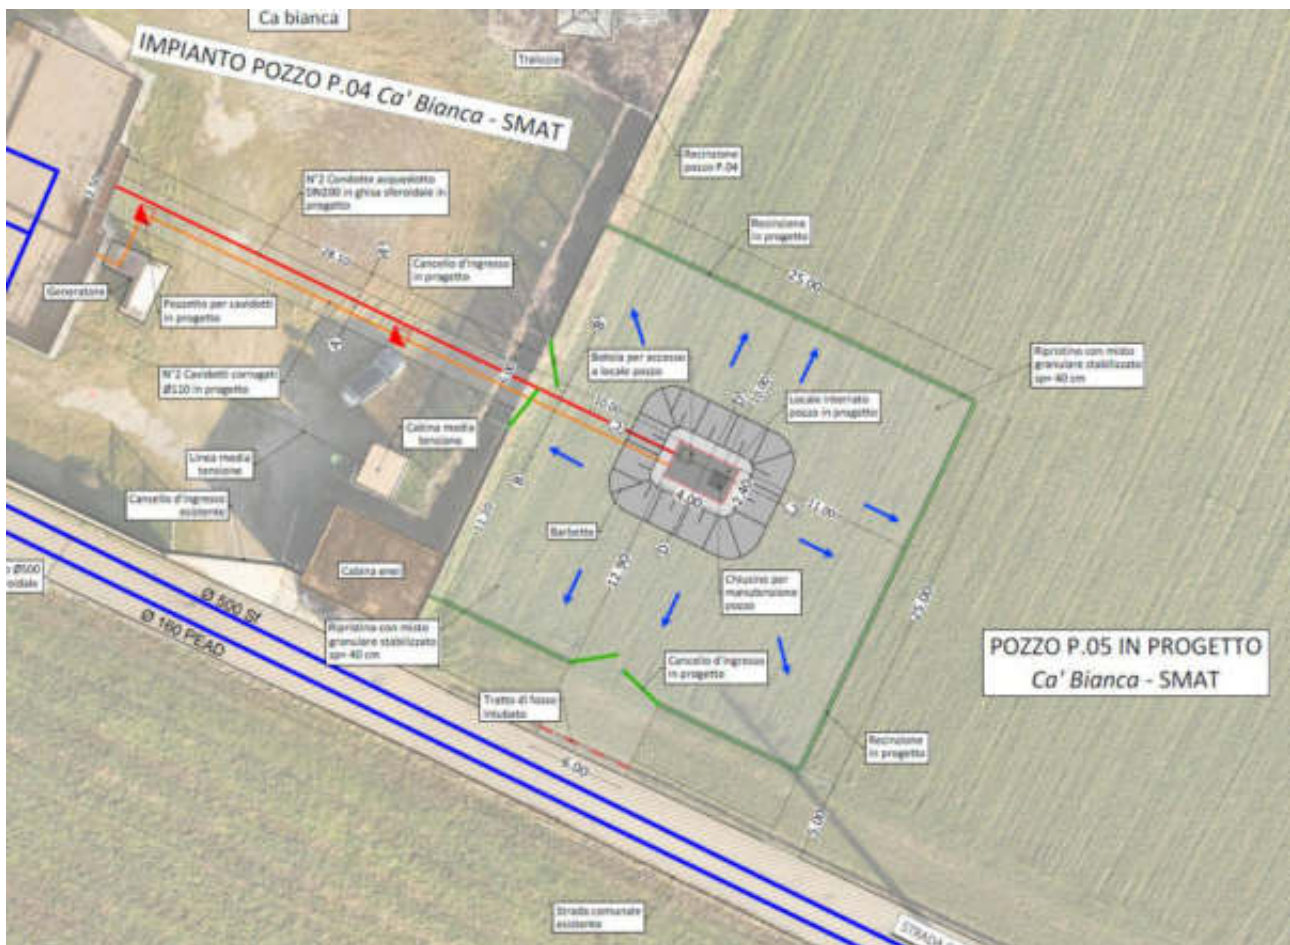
Estratto planimetria di progetto pozzo *Ca bianca
